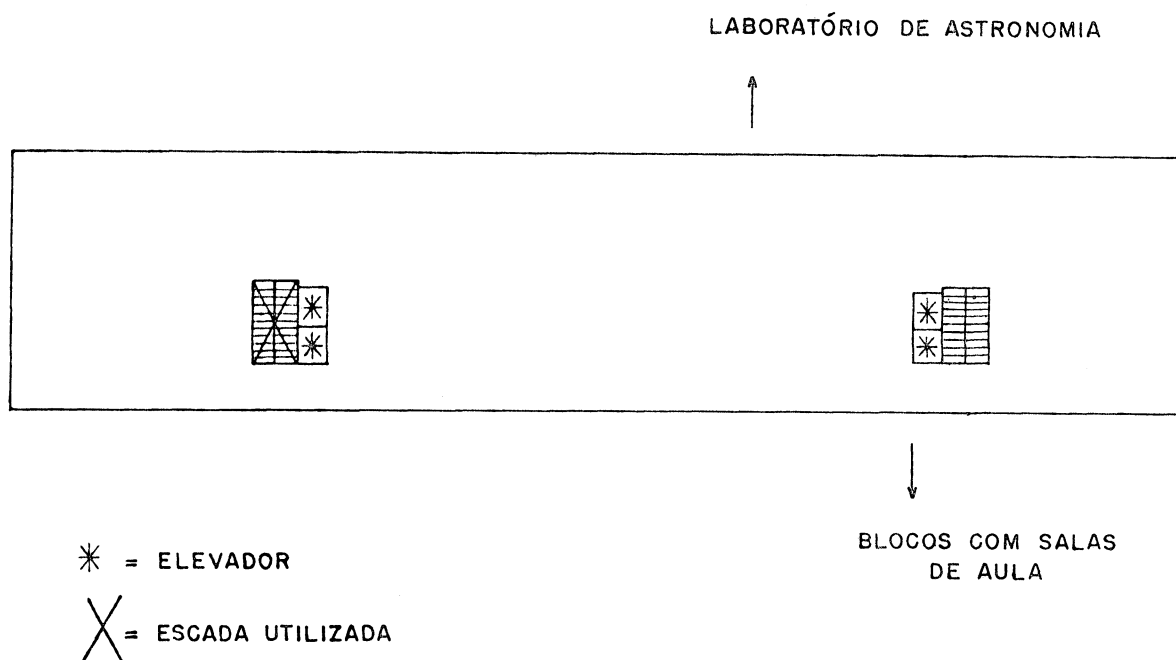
Croquis em planta baixa com a localização da escada utilizada nas medições.
